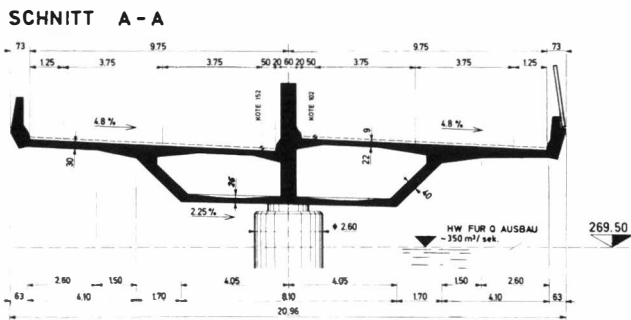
Brückenquerschnitt (Schnitt A - A) – Coupe en travers (A - A) – Cross section (A - A)
